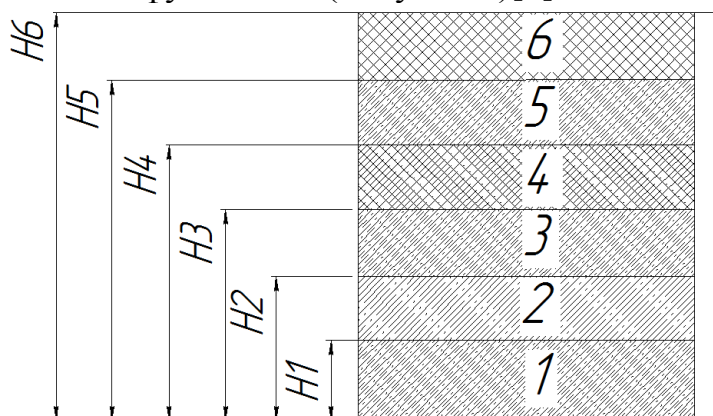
Фундаментное основание низкотемпературного резервуара для хранения СПГ бетонные сваи, 2- слой с теплообменниками, 3- опорный фундамент, 4- амортизирующие прокладки, 5- наружная оболочка, 6- блоки пеностекла.
